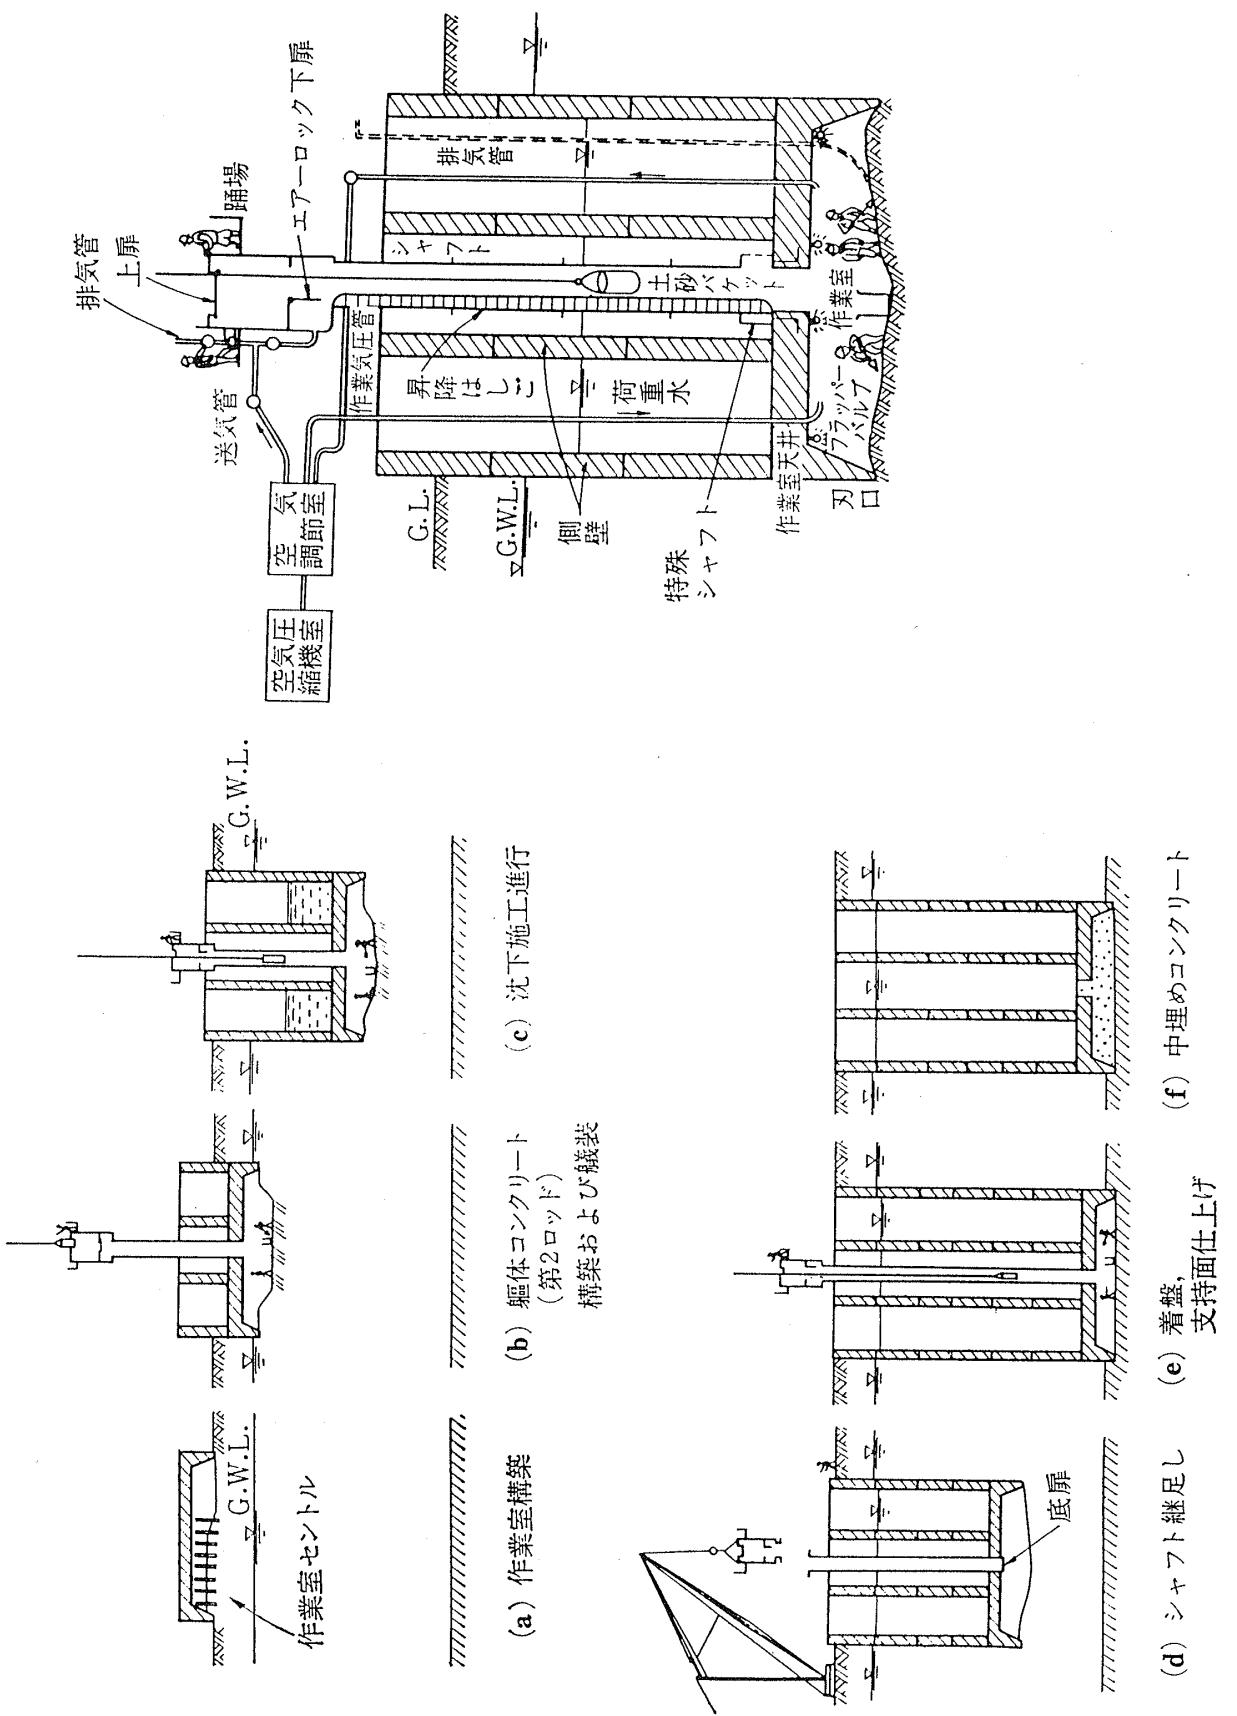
ニューマチャックケーソン工法¹⁹³⁾
